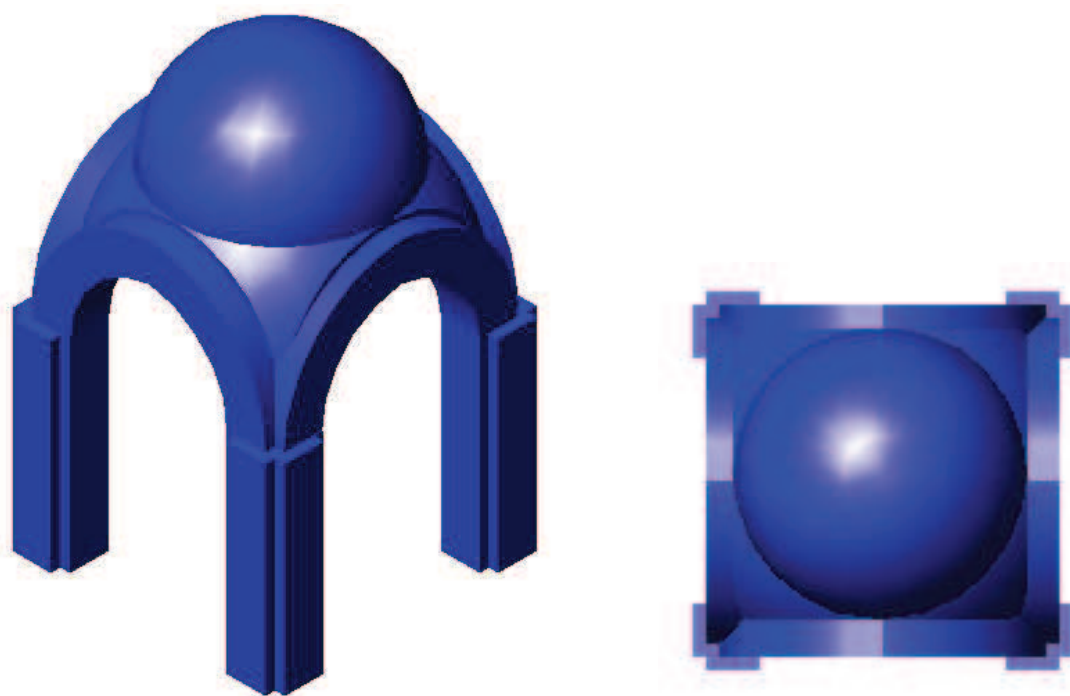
Esquema completo en axonetría y planta. (Construcción 3D del autor)
